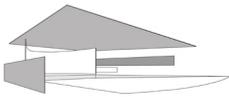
Plano de sección longitudinal de la Planta Glenn Martin.
